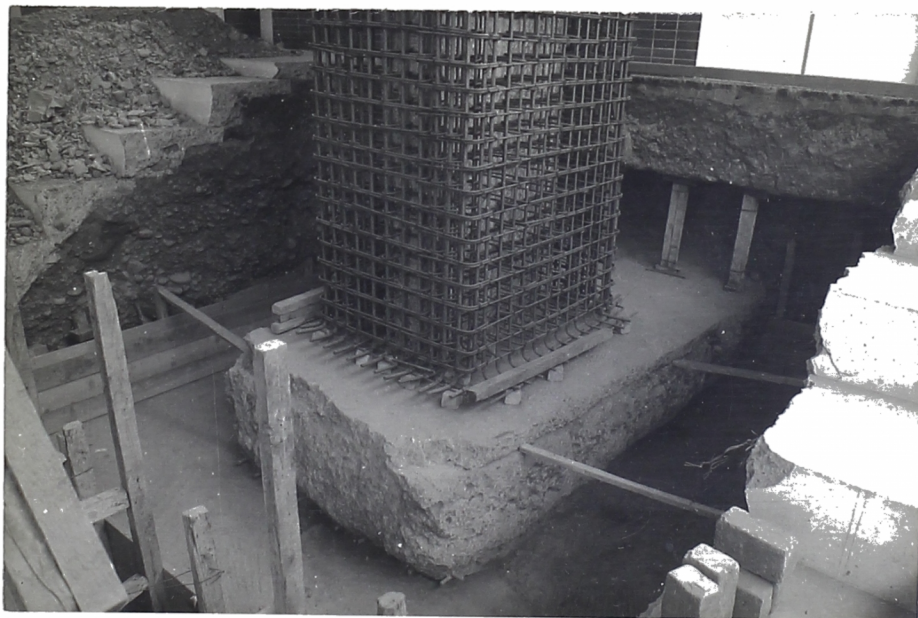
ZAPATA Y SUELO DE CIMENTACION
